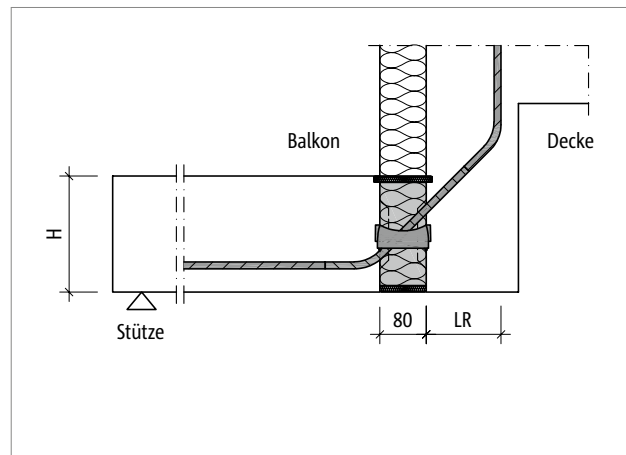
Schöck Isokorb® T Typ QL-WO: Balkon mit Höhenversatz nach unten und Außendämmung
